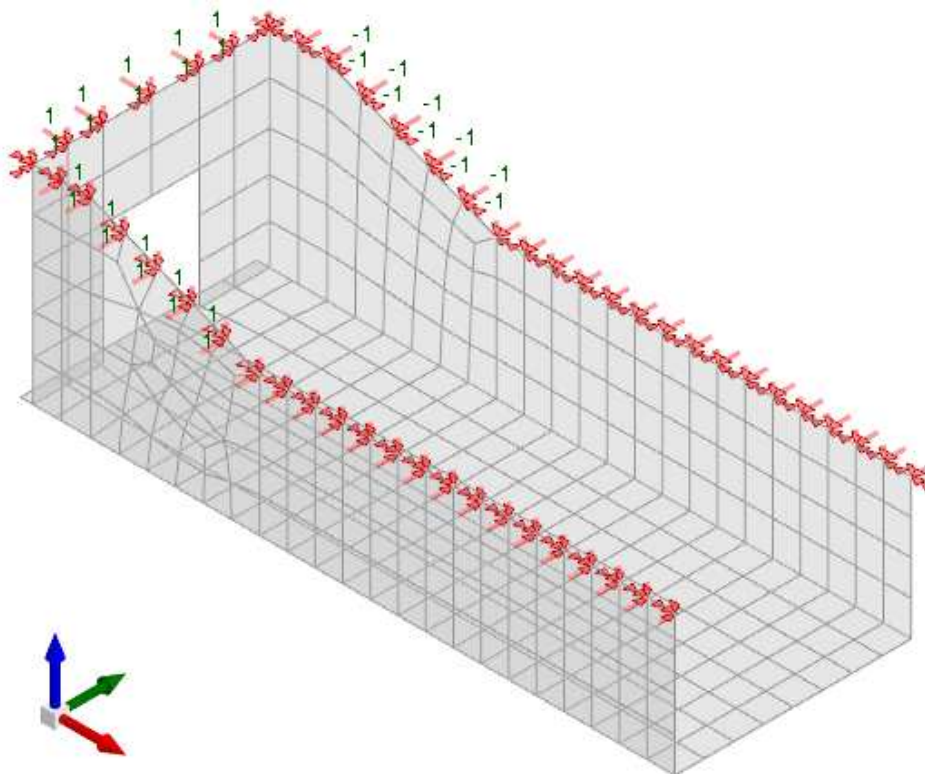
Condizione permanenti NON strutturali [daN] (parapetto)
